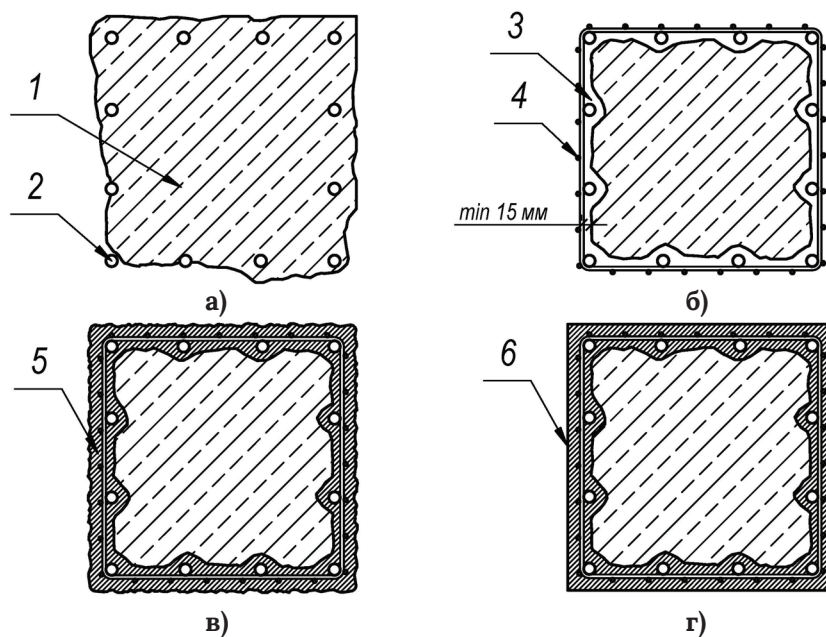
Ремонт и усиление монолитной плиты перекрытия методом бетонирования
